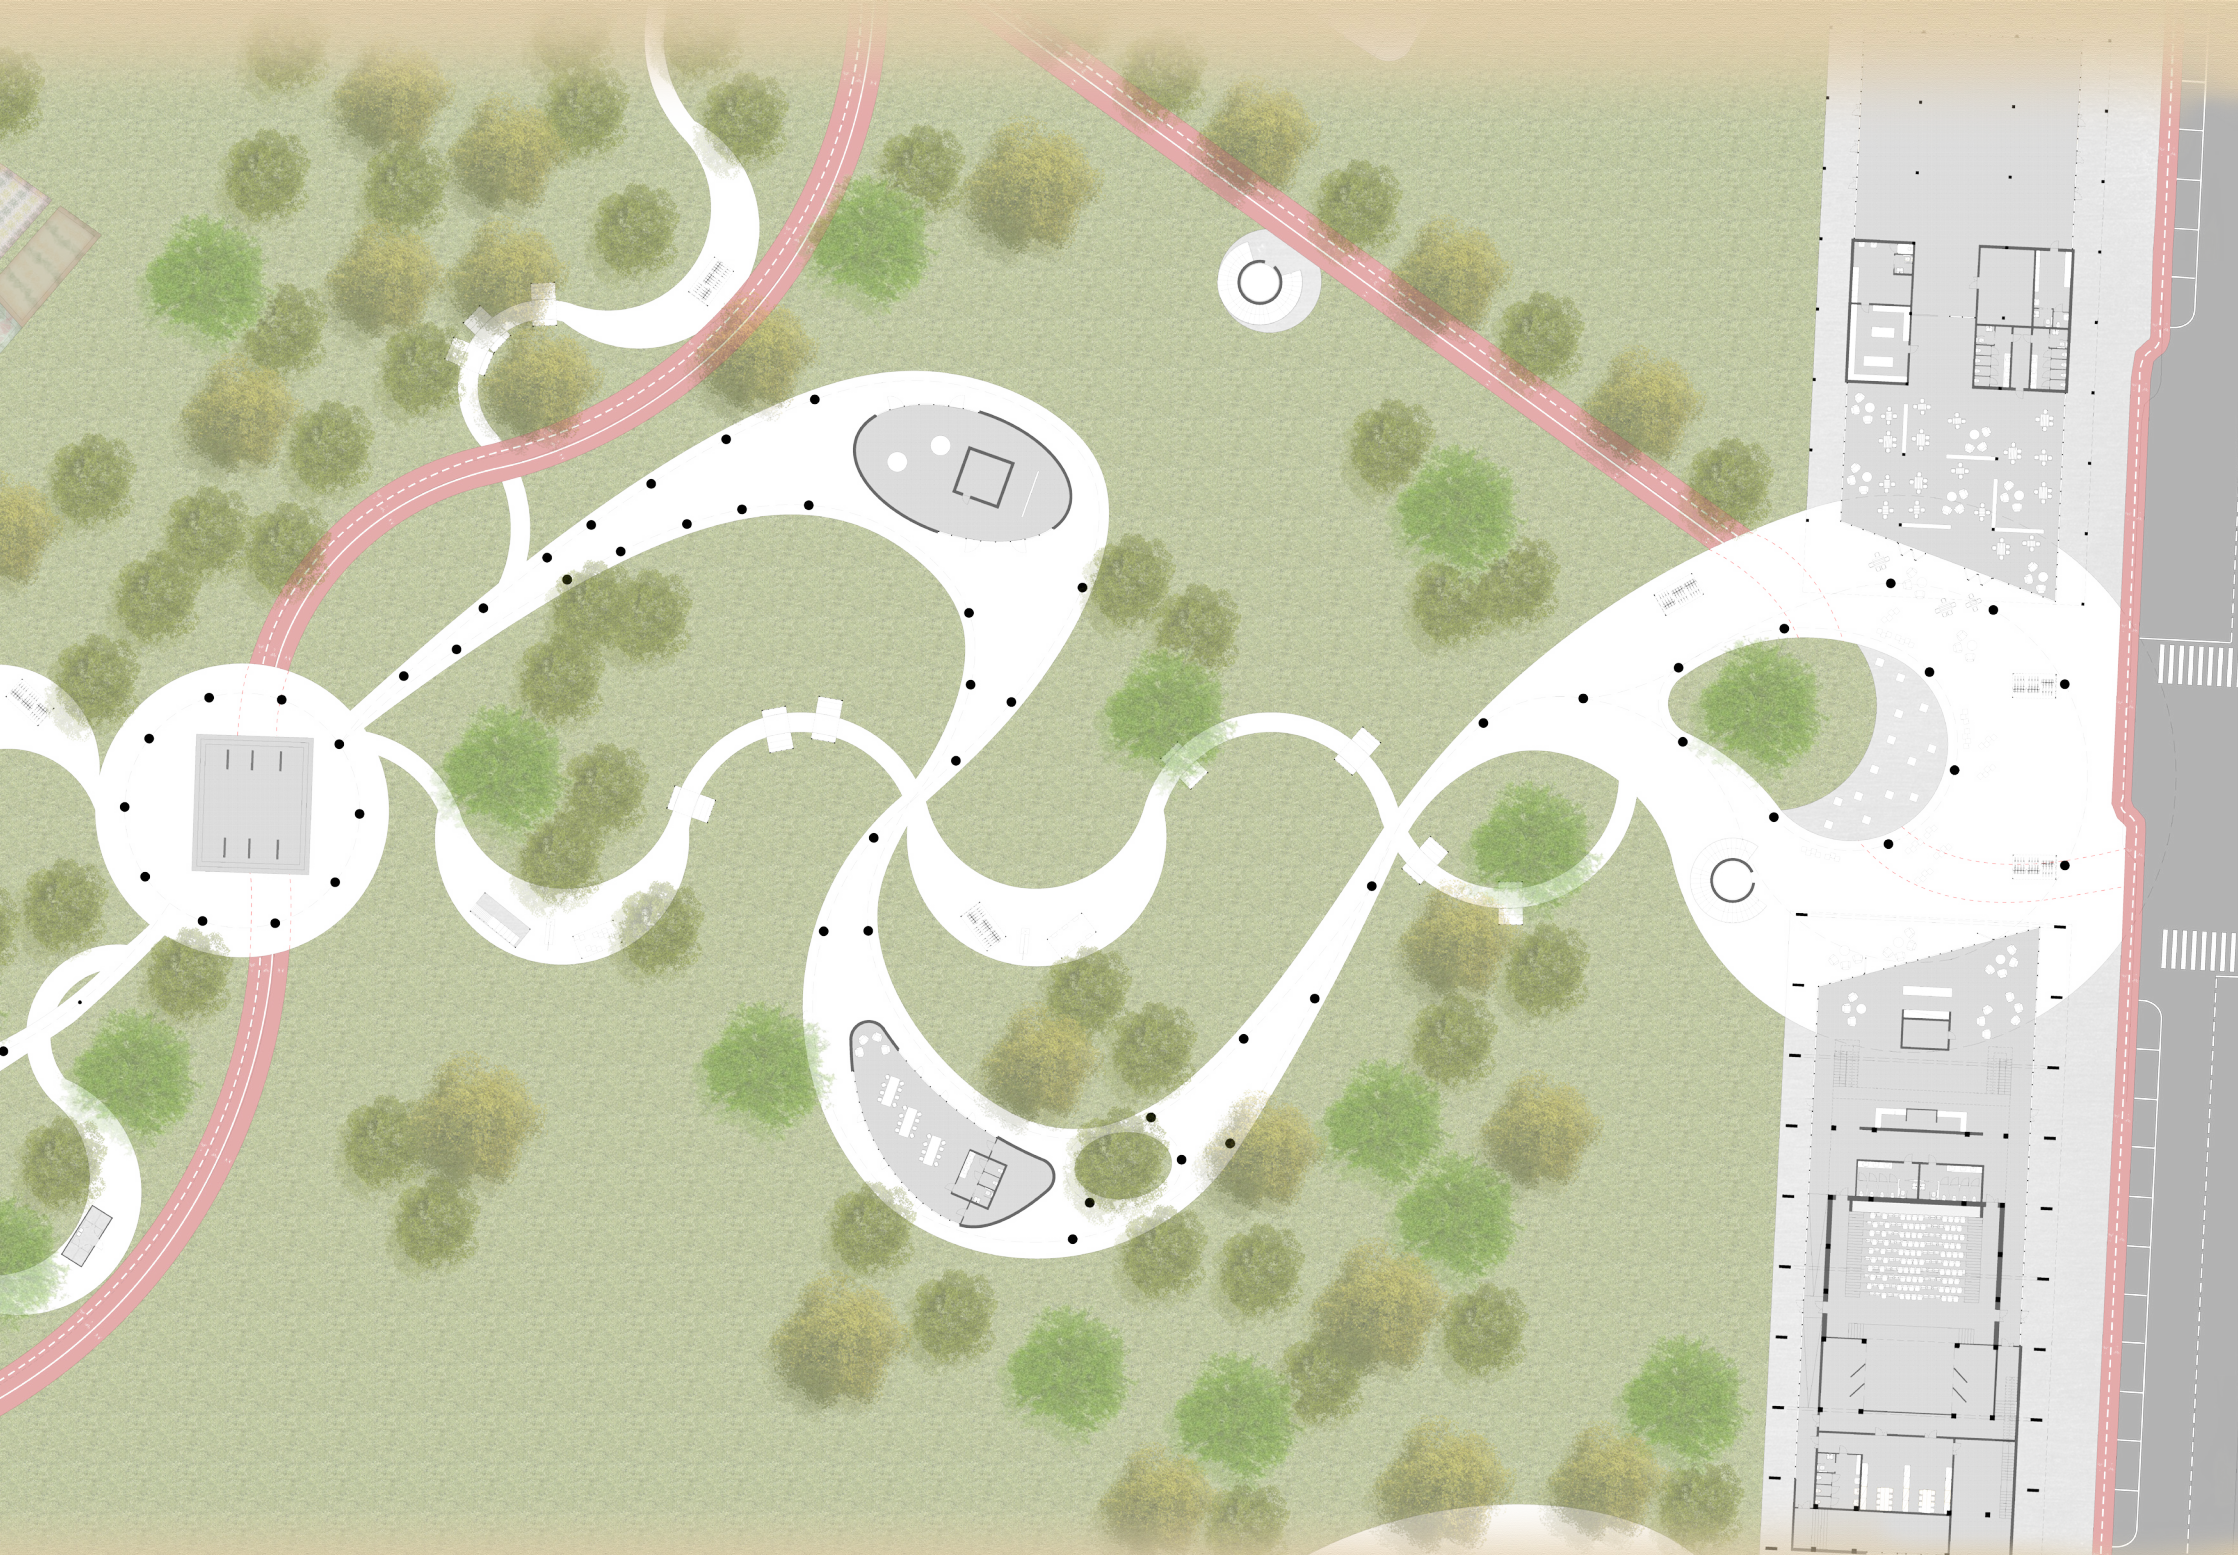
Pianta piano terra fascia centrale- particolare della piazza del teatro.
